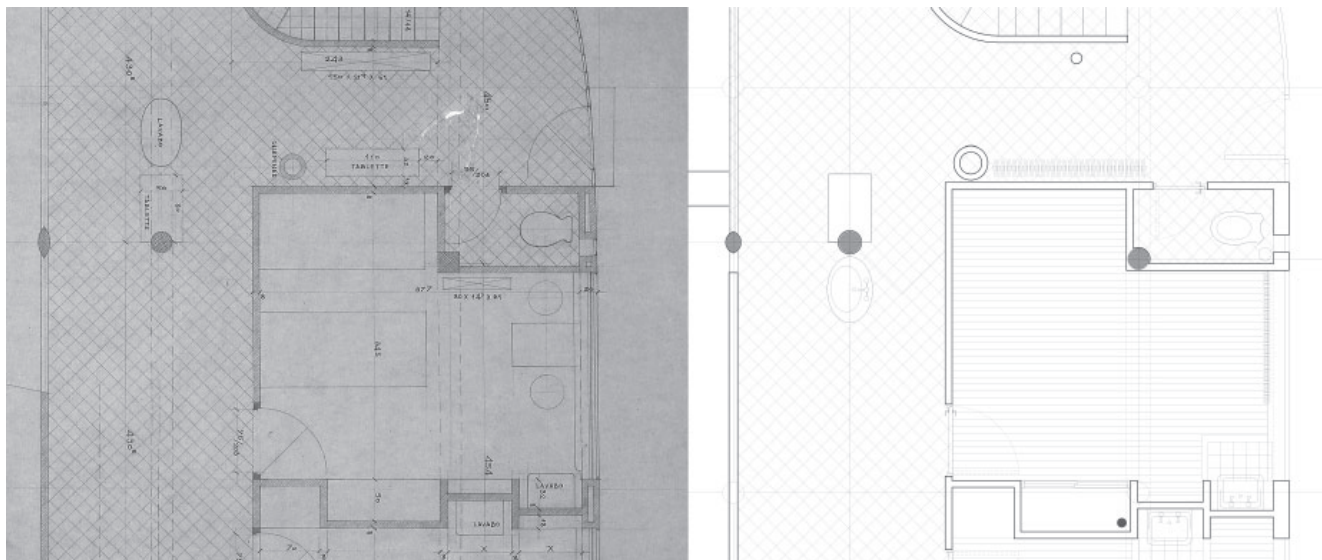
Detalle del plano de planta baja de la *Villa Savoye*, a escala 1:20 (FLC 19441A), comparado con la realidad construida. Elaboración propia.
